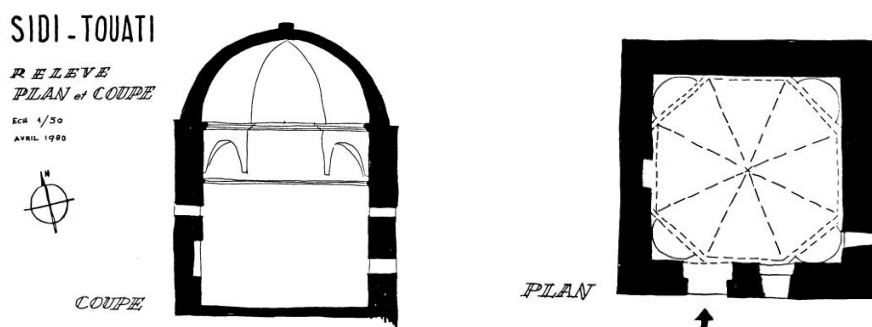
plan et coupe du tombeau de Sidi Touati
